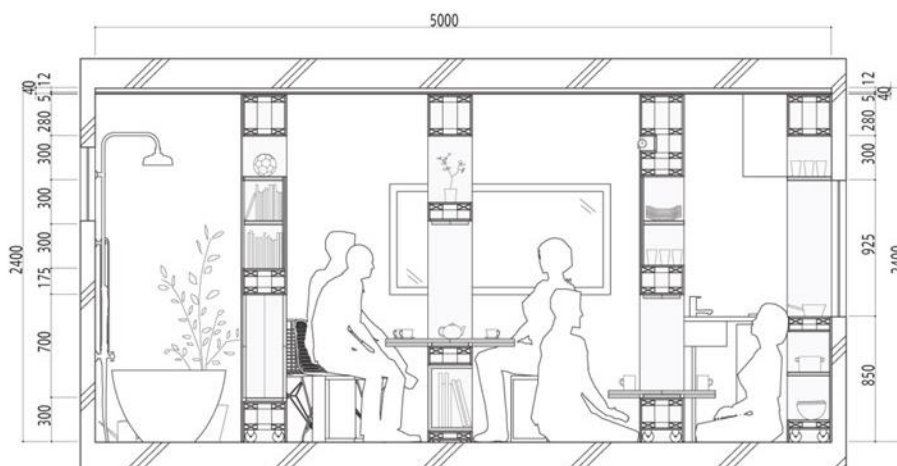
Corte del proyecto, 2014. Fuente: Plataforma Arquitectura.
